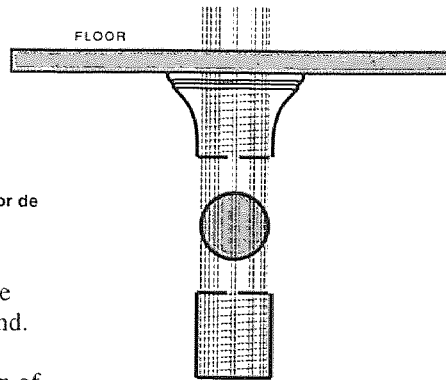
'Flat slab system', waarin de dragende balken geïntegreerd zijn in de betonnen vloer
